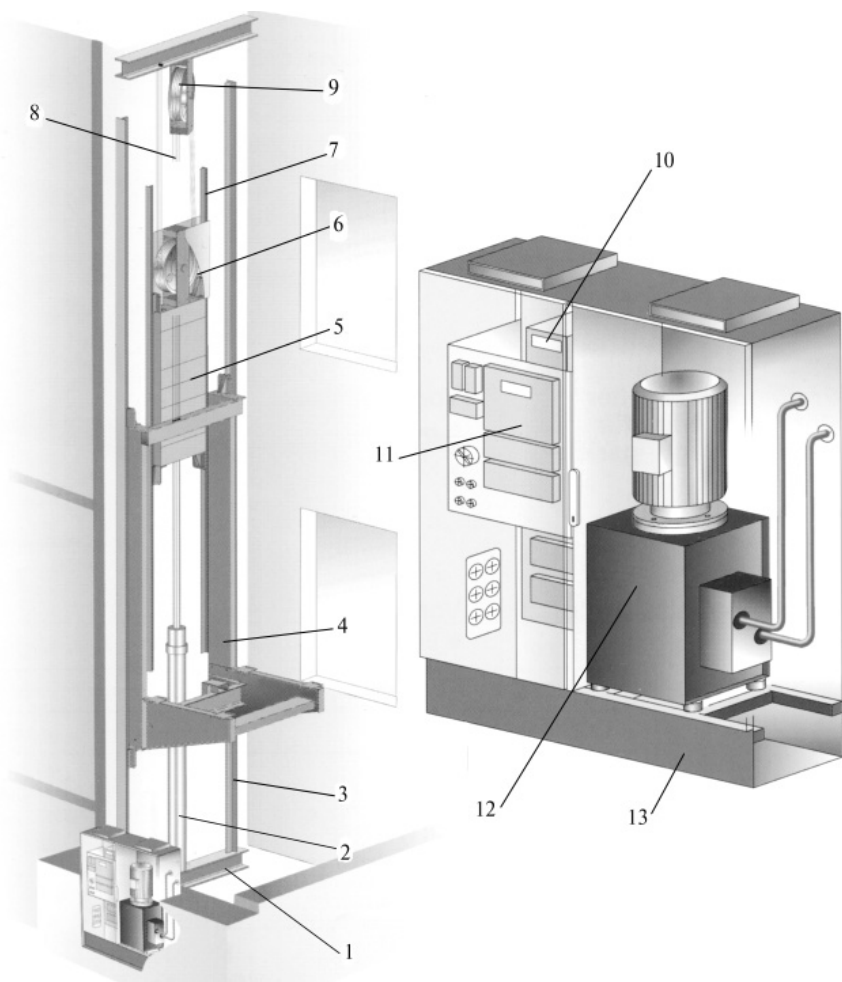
Гидравлический лифт с противовесом (Leistrizt AG): 1 — опорная рама; 2 — гидроцилиндр; 3 — направляющие кабины; 4 — рама кабины; 5 — противовес; 6 — подвижный блок мультипликатора; 7 — направляющие противовеса; 8 — канаты мультипликатора; 9 — неподвижный блок; 10 — частотный преобразователь привода насоса; 11 — станция управления; 12 — гидроагрегат; 13 — шкаф для размещения оборудования
